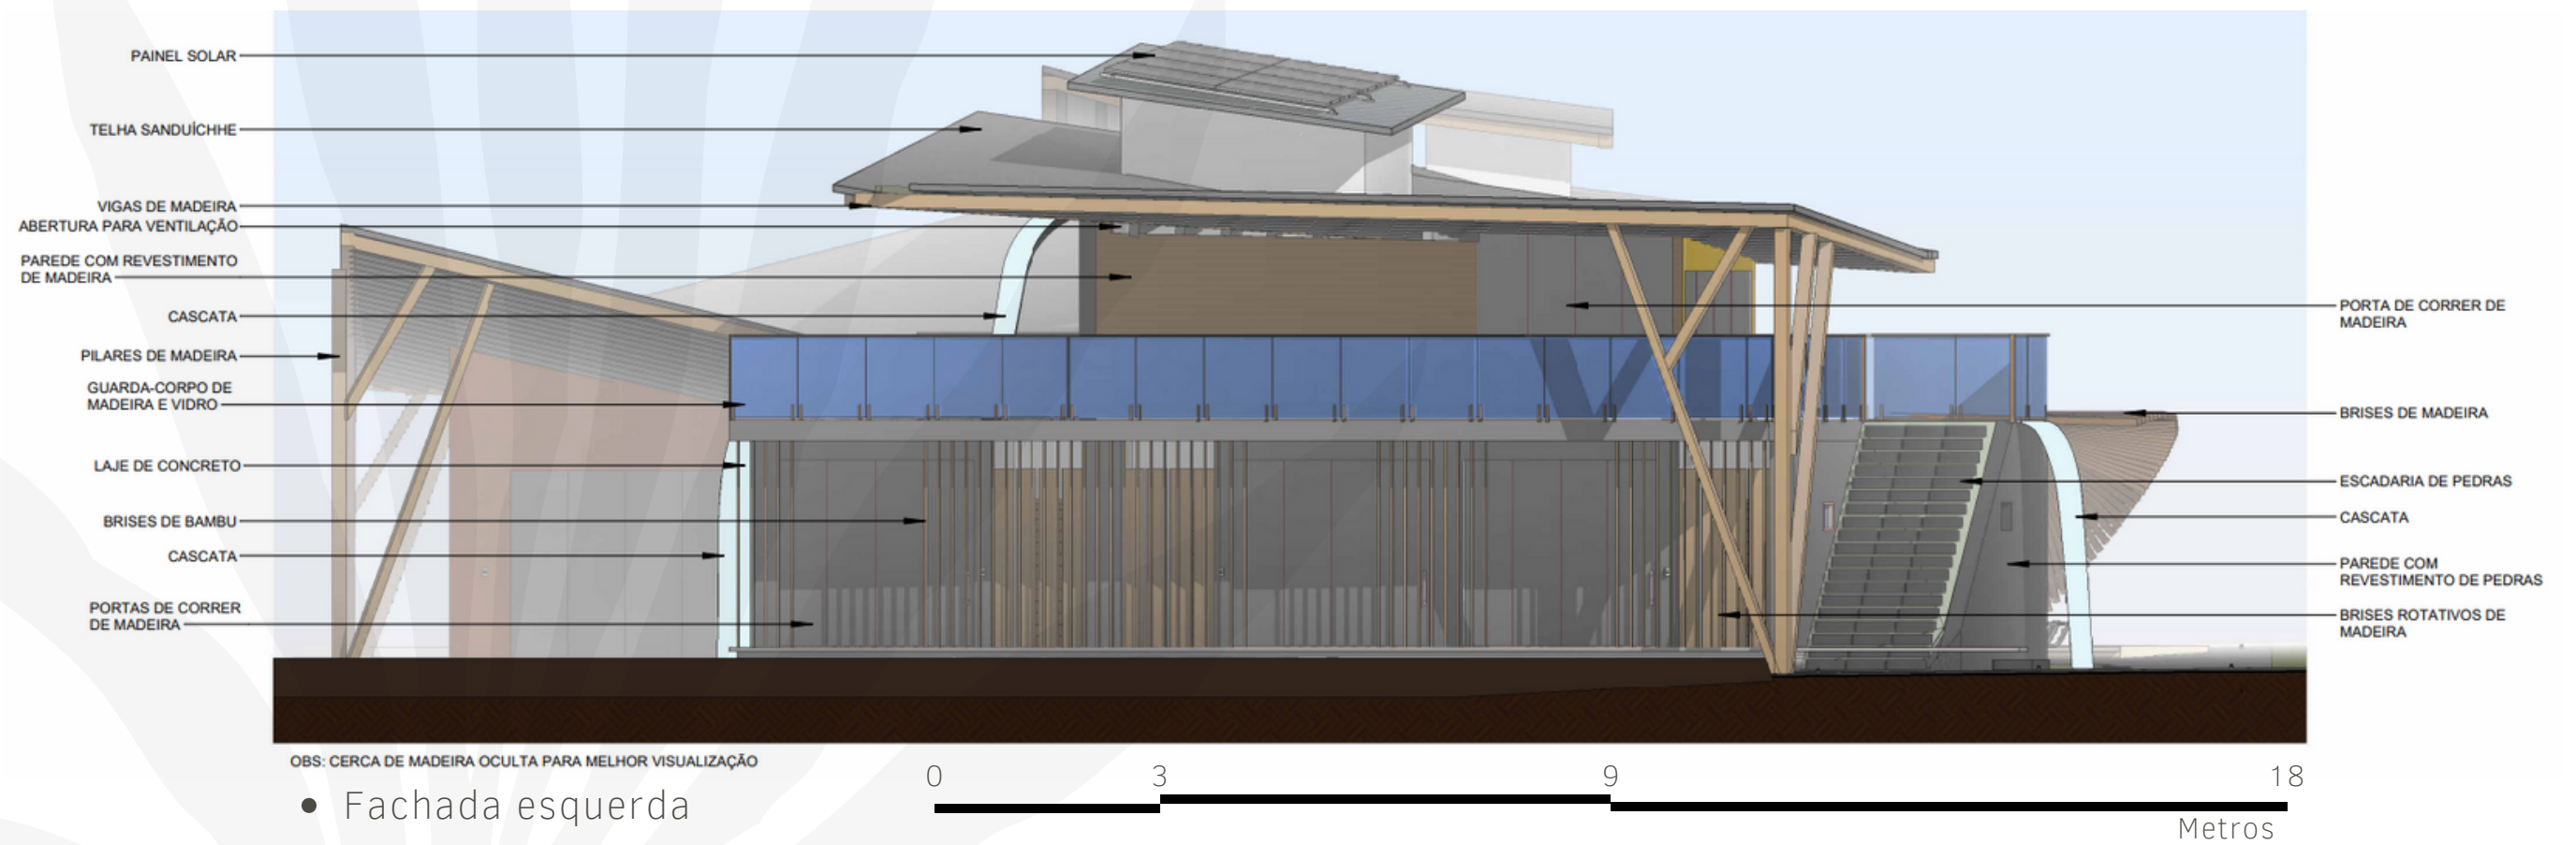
Fachada esquerda. Fonte: Elaboração própria da autora.
